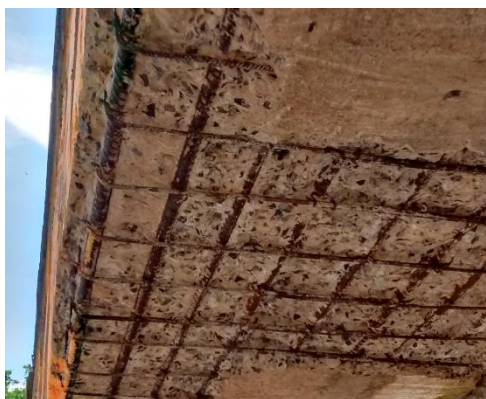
Delaminação parcial de camadas de betão. (Silva, 2018)
